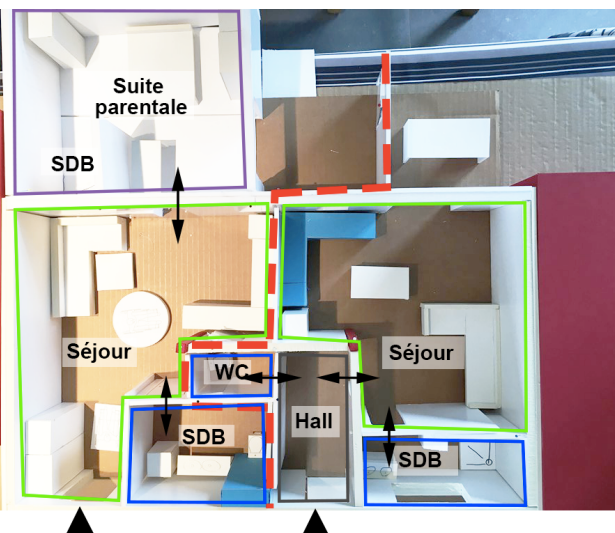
Photo de la maquette après division du logement (Atelier V2)
